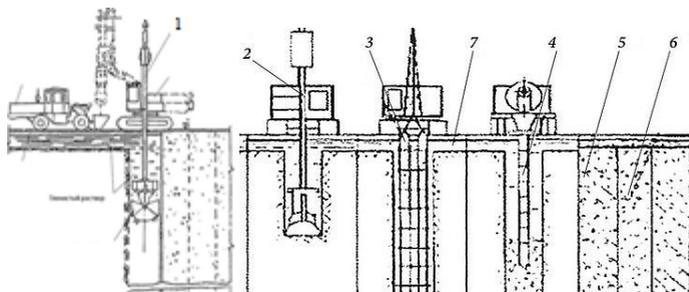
Схема возведения подземных сооружений методом «стена в грунте» а — разработка грунта грейфером; б — схема работ: 1 — форшхта; 2 — разработка грунта на захватке; 3 — установка арматуры; 4 — бетонирование вертикально перемещаемой бетонолитной трубой; 5 — устройство обвязочного пояса по периметру; 6 — готовая стена; 7 — глиняный раствор
